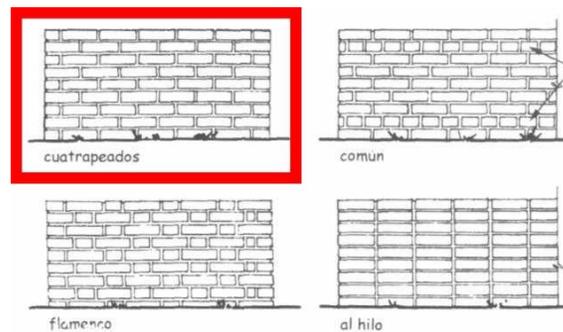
Configuraciones de la Mampostería. (Fuller Moore, pág. 244)
